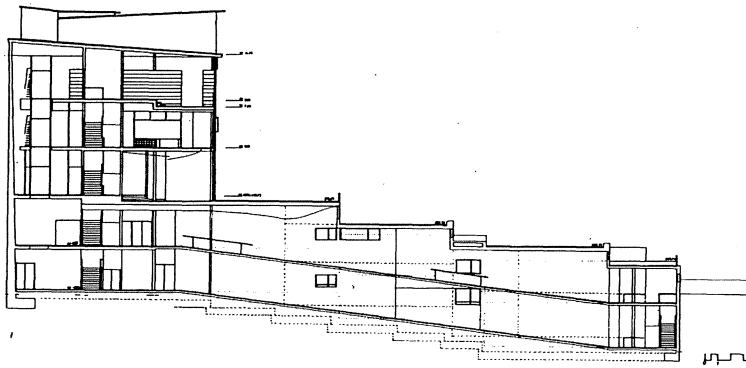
SECCION POR LA RAMPA CENTRAL.
